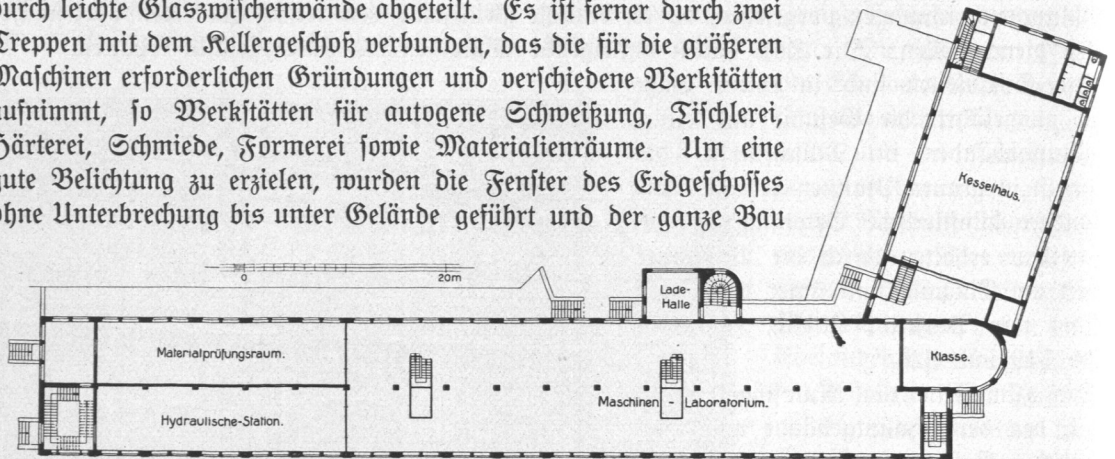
Technische Staatslehranstalten, Grundriß vom Maschinenlaboratorium und Kesselhaus.
